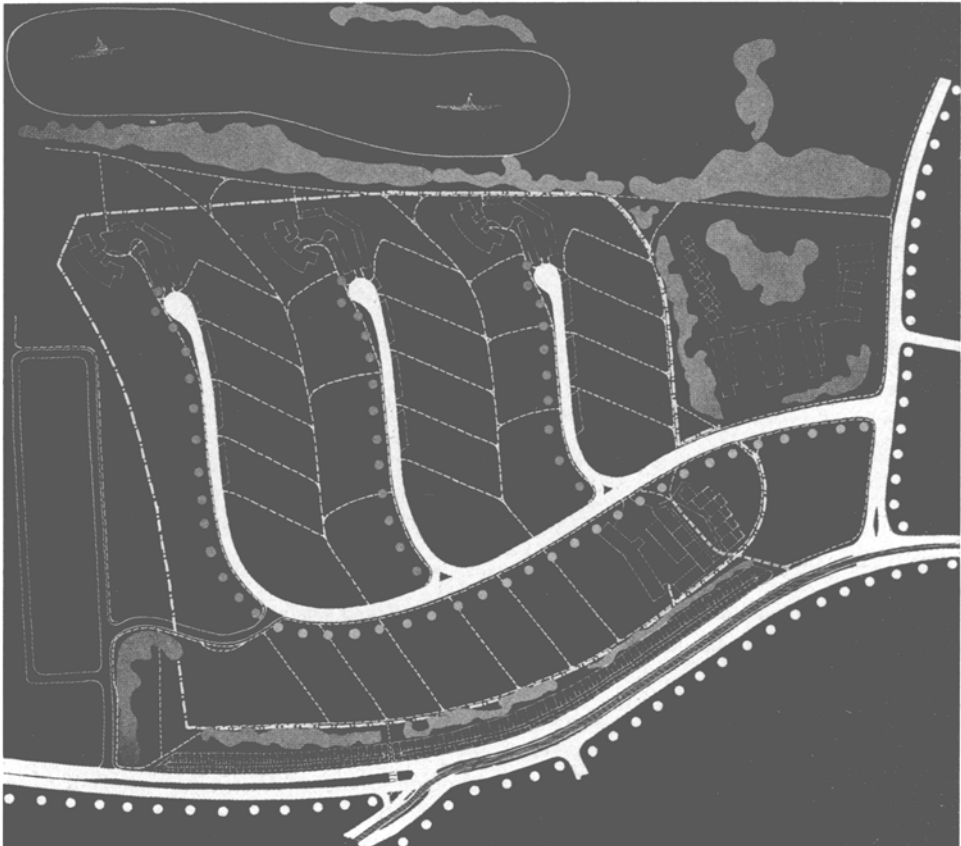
Verkehrsplan. Lärmschutzwall unten. Der nördliche Fußweg an der Rothenburger-Straße verläuft hinter dem Lärmschutzwall
